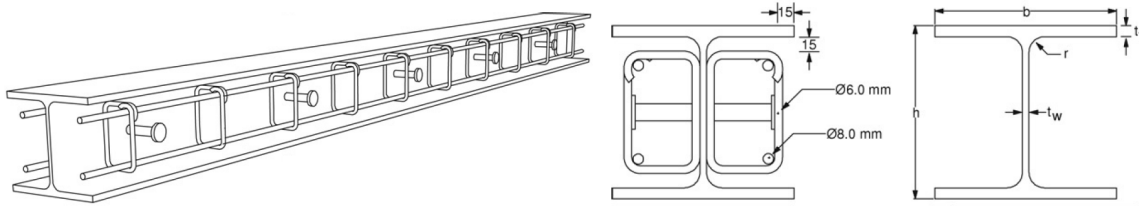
Secção e distribuição de armaduras da viga C20Y0 (adaptado de Elghazouli e Treadway, 2008).
